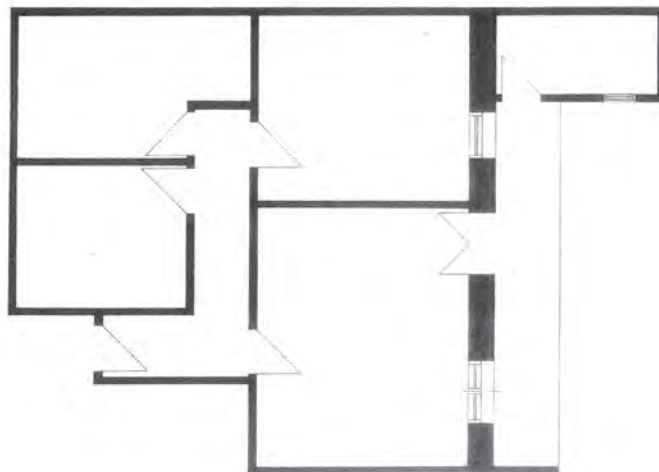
16. 1970 ESTADO DE LA PLANTA BAJA TRAS LA REFORMA
